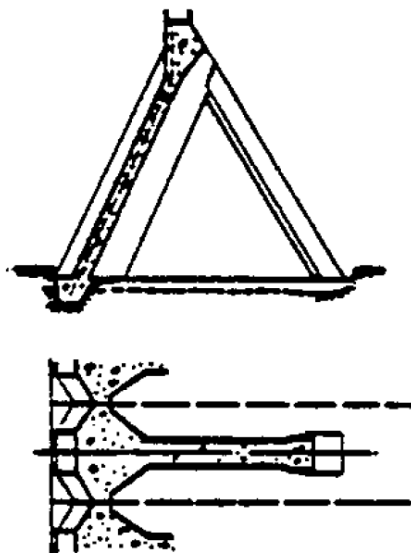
Planta e perfil transversal de barragem de betão do tipo contrafortes. Adaptado de (Quintela 1990)
